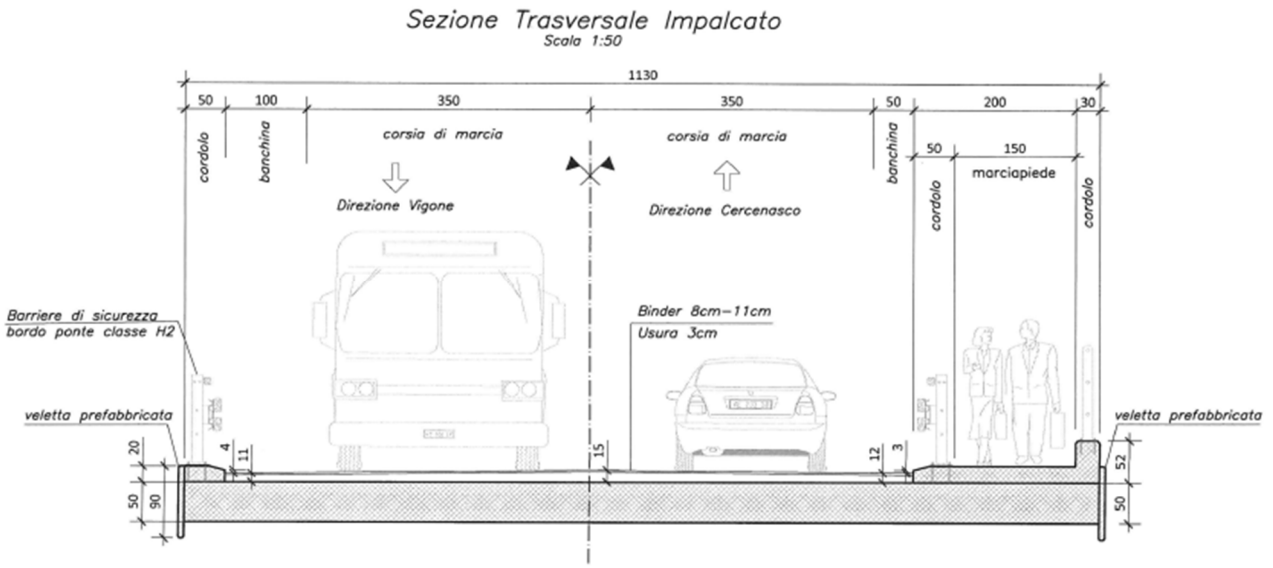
Sezione trasversale impalcato (elaborato non in scala)
